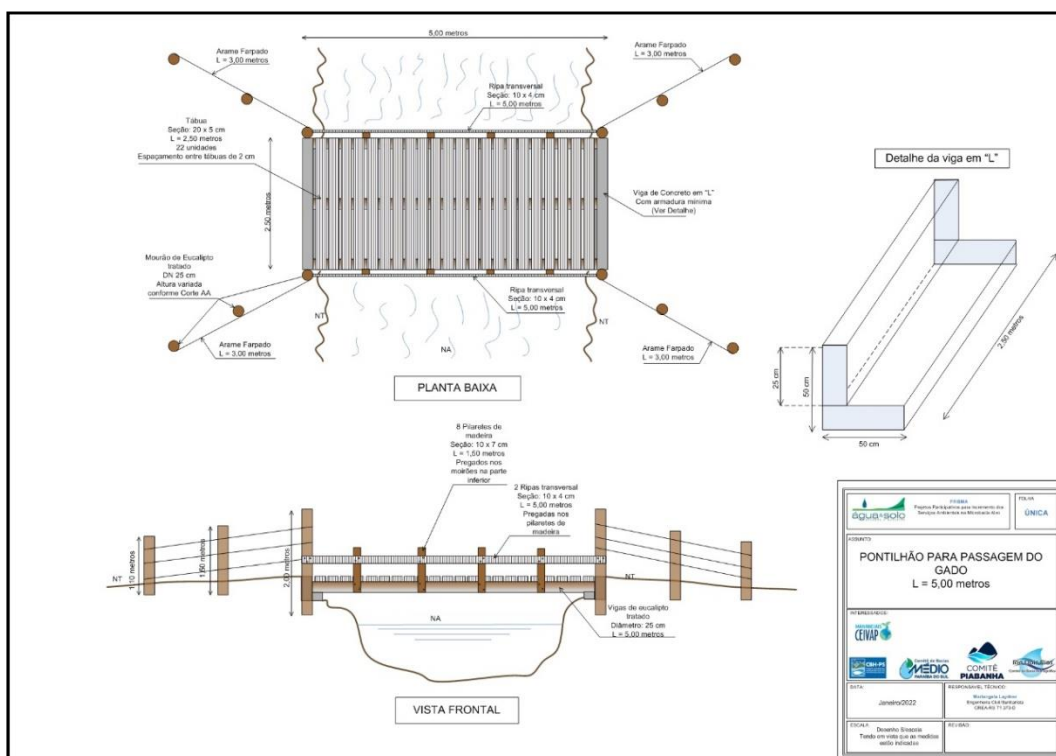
Planta baixa e vista frontal do pontilhão de 5,0X2,5m
